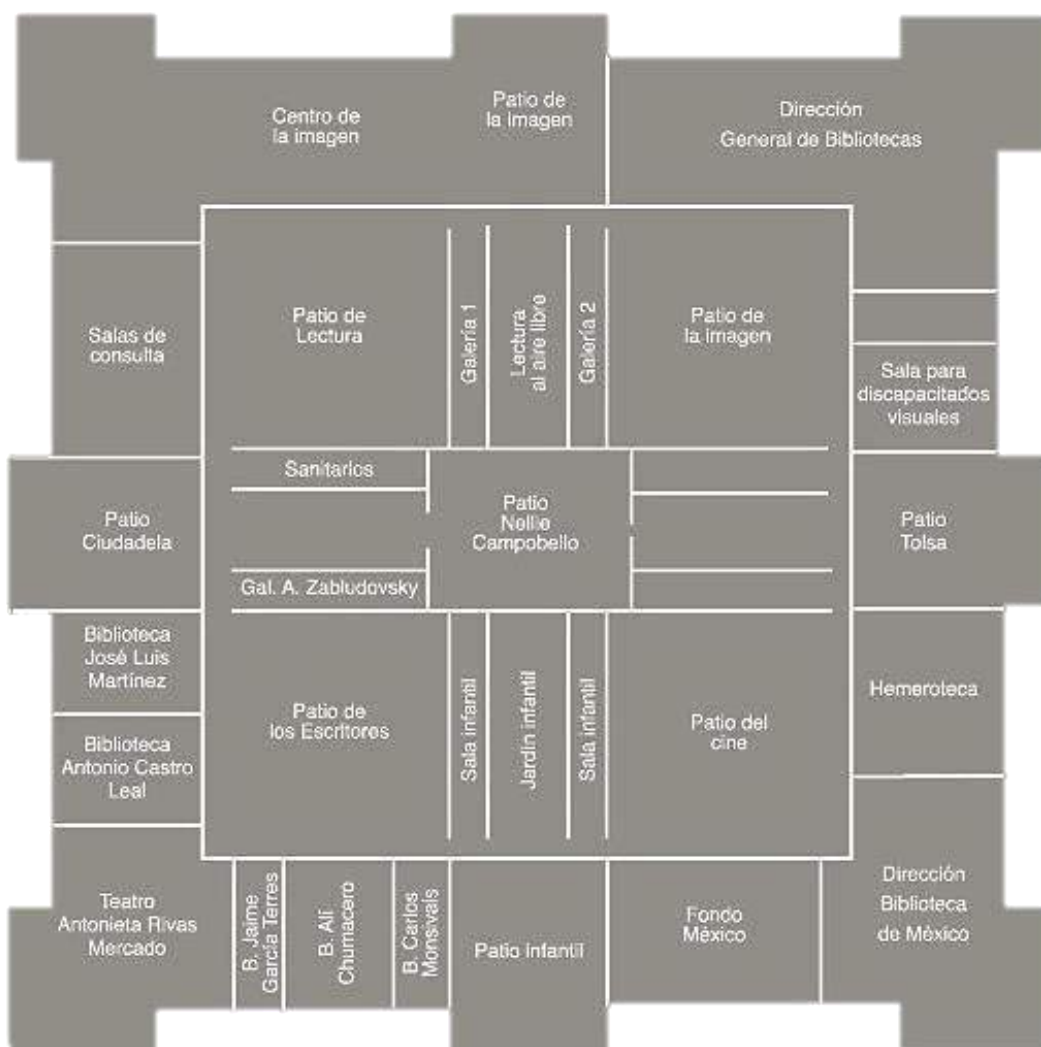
Programa arquitectónico de La Ciudadela sobre la planta general.
